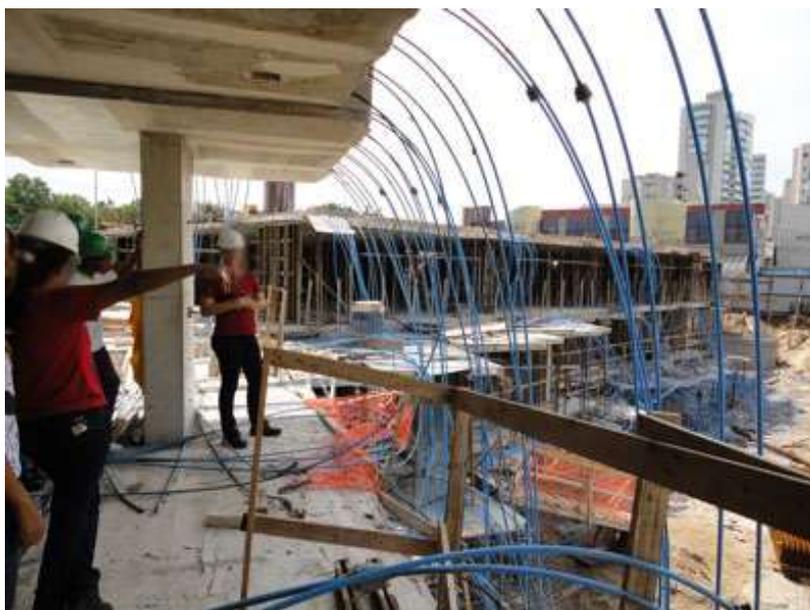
Engenheiro tirando dúvidas dos alunos com auxílio da planta baixa (23/10/2012).
